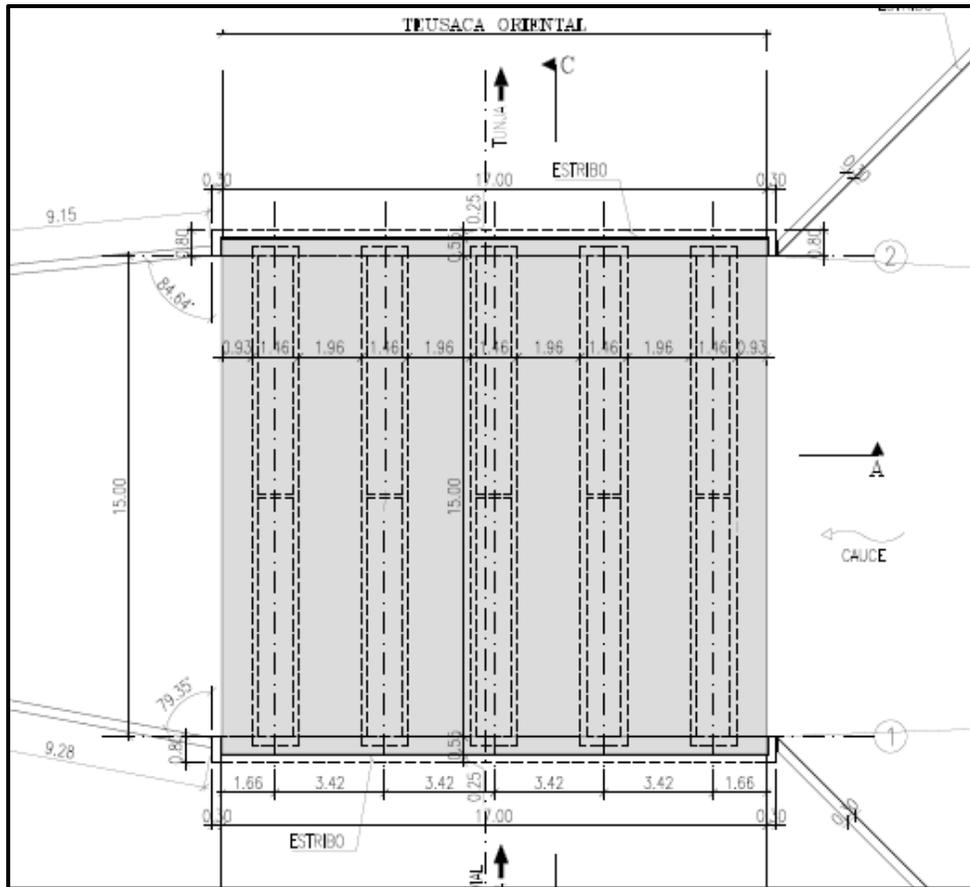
Vista en planta Puente Vehicular Teusaca Oriental
